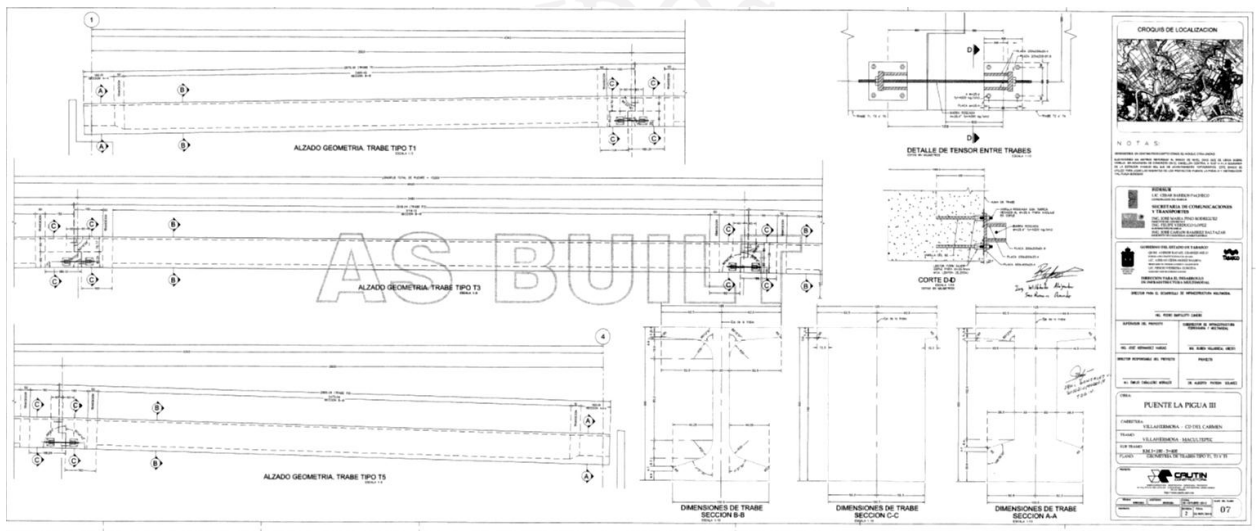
Plano AS BUILT del puente La Pigua III.
